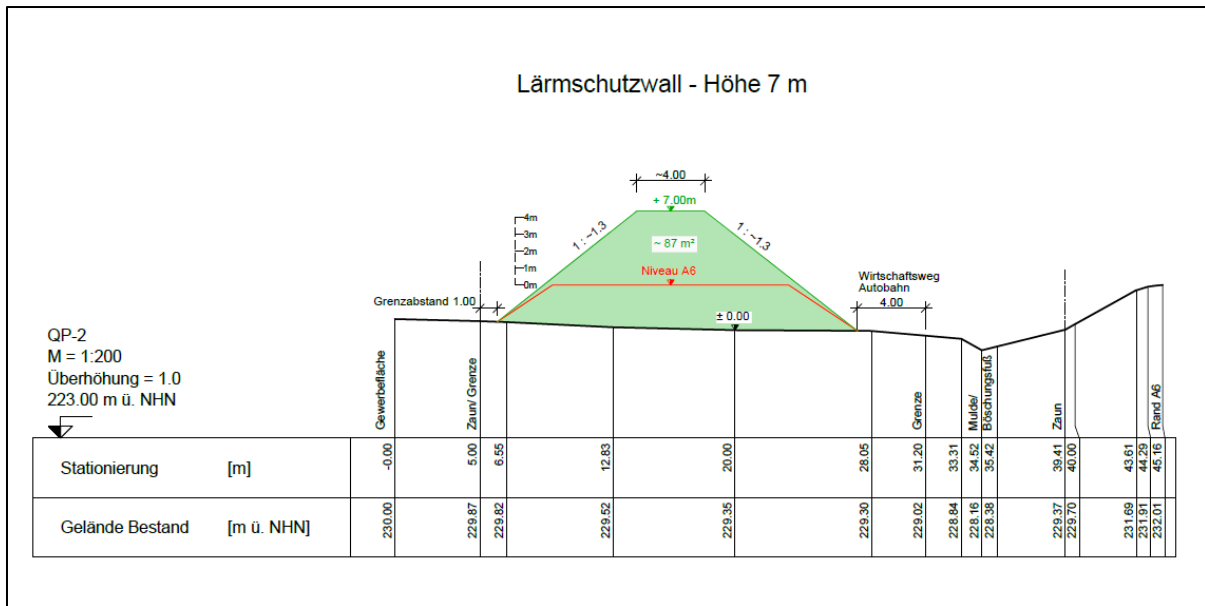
Querprofil Lärmschutzwall - Höhe 7 m
